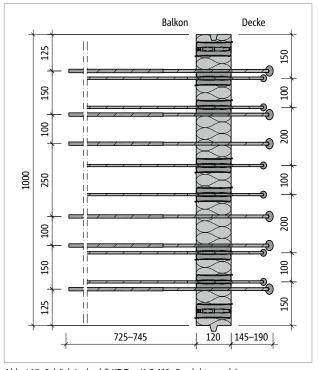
Schöck Isokorb $^{\otimes}$  XT Typ K-O-M2: Produktgrundriss
